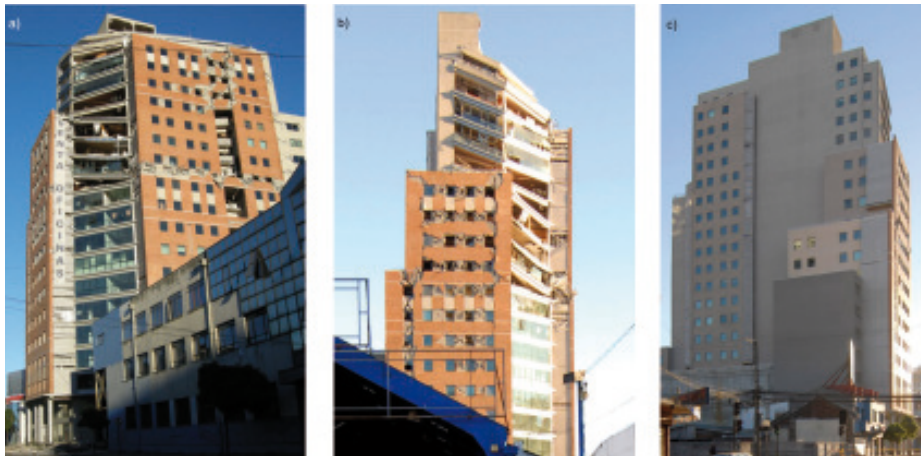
20-stöckiges Stahlbetontragwandgebäude O'Higgins in Concepción: Vorder-, Seiten- und Rückansicht.
